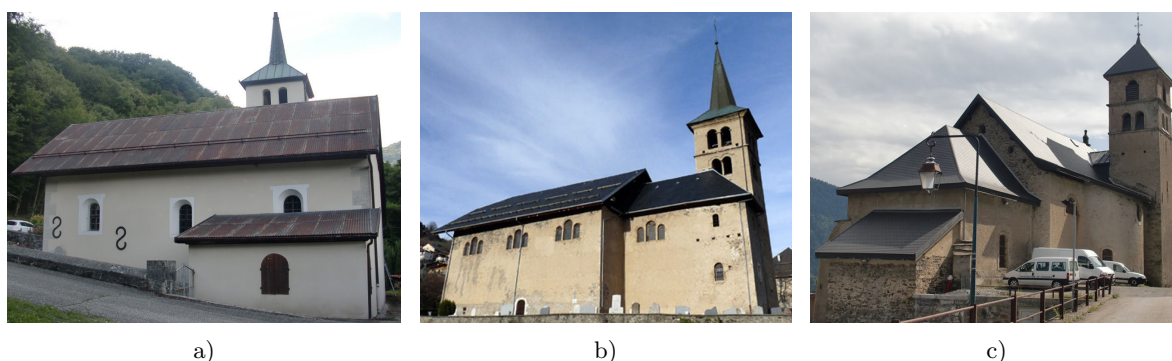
Discontinuité entre la nef et le chœur. a) Saint-Thomas, Esserts-Blay : continuité en plan et élévation. b) Saint-André, Doucy, La Léchère : discontinuité en plan, pan de mur en second-œuvre. c) Saint-Sauveur, Héry-sur-Ugine : discontinuité en plan et élévation.
